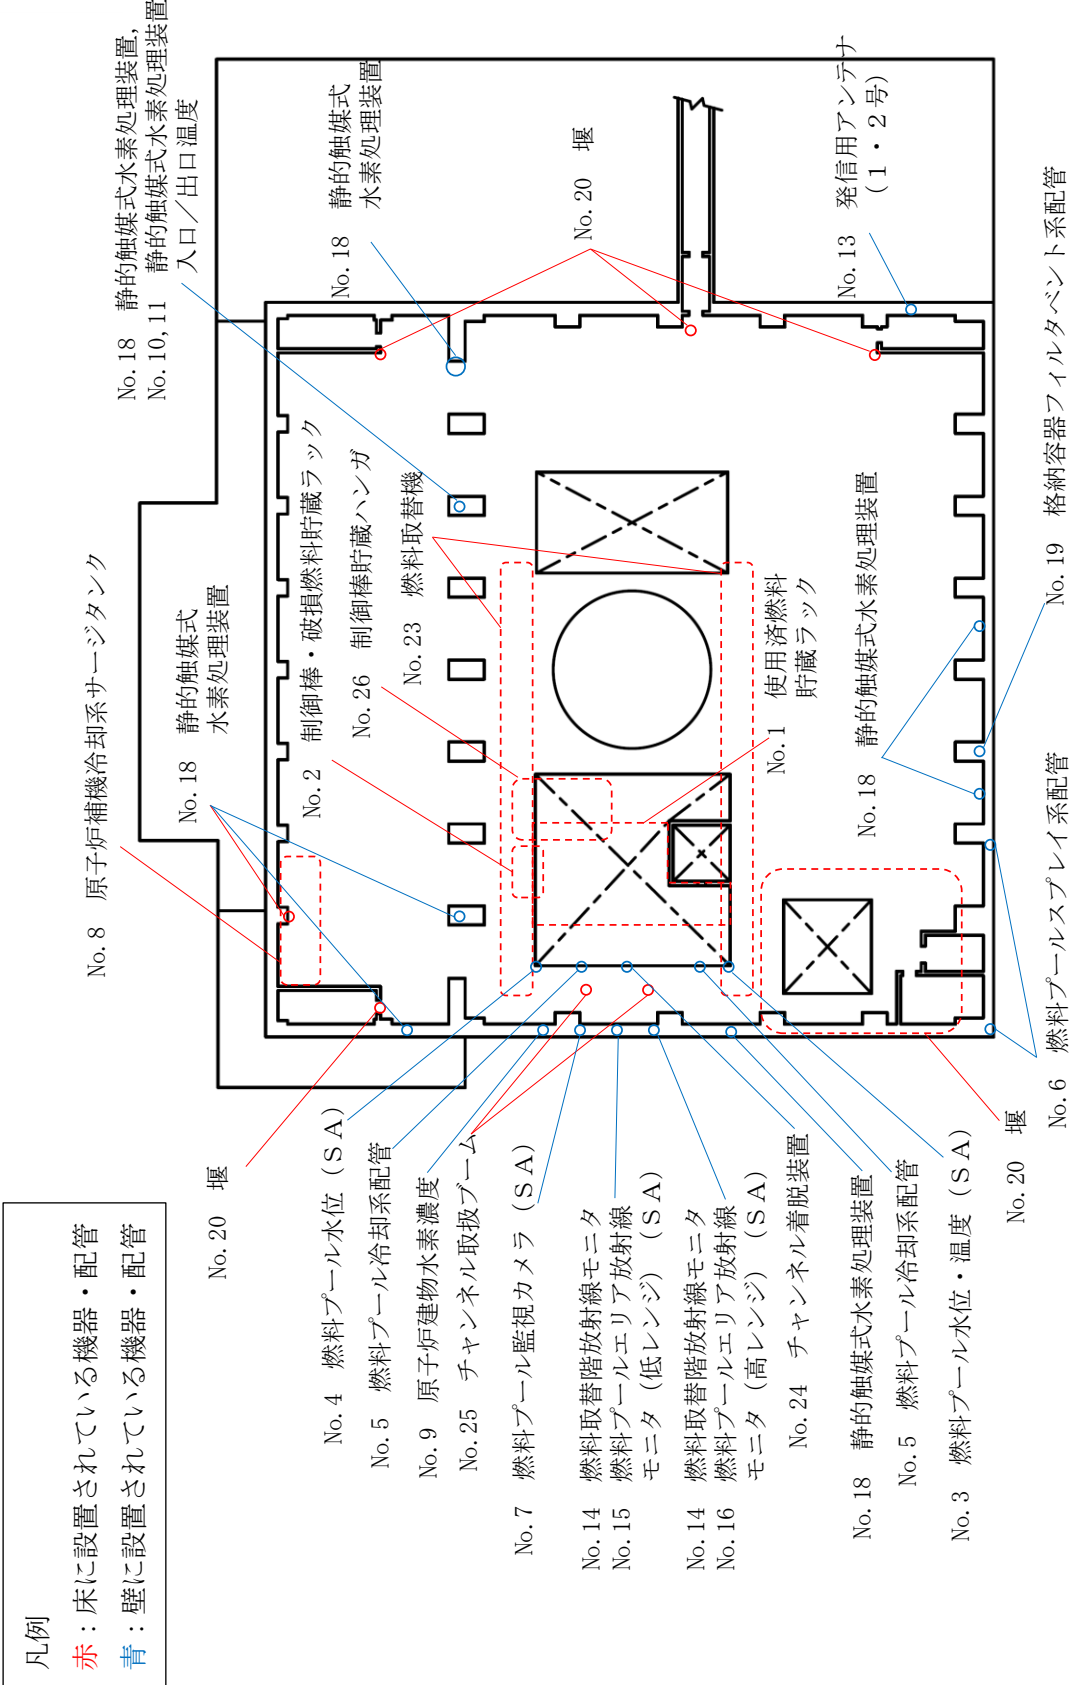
(1) 影響検討対象設備の概略配置図 (平面図 EL 42.800m)
